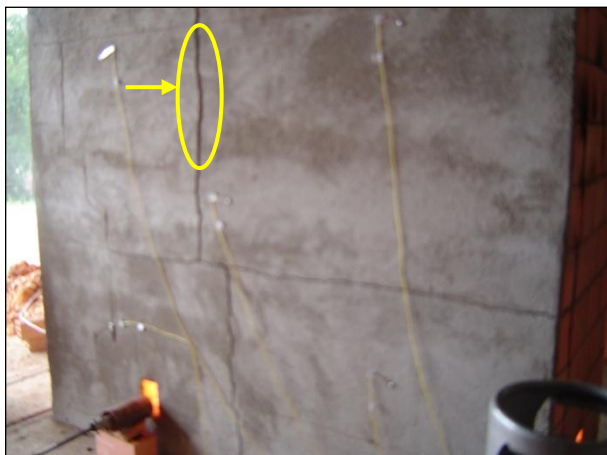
Parede com revestimento e com preenchimento ao final do ensaio, com a localização da principal fissura.
